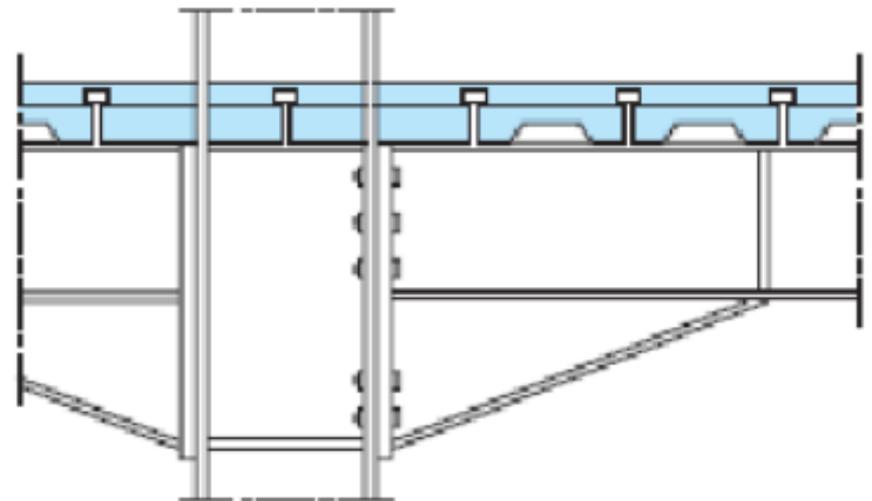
Assemblages de type poutre-poteau pour des ossatures mixtes semi-continues
